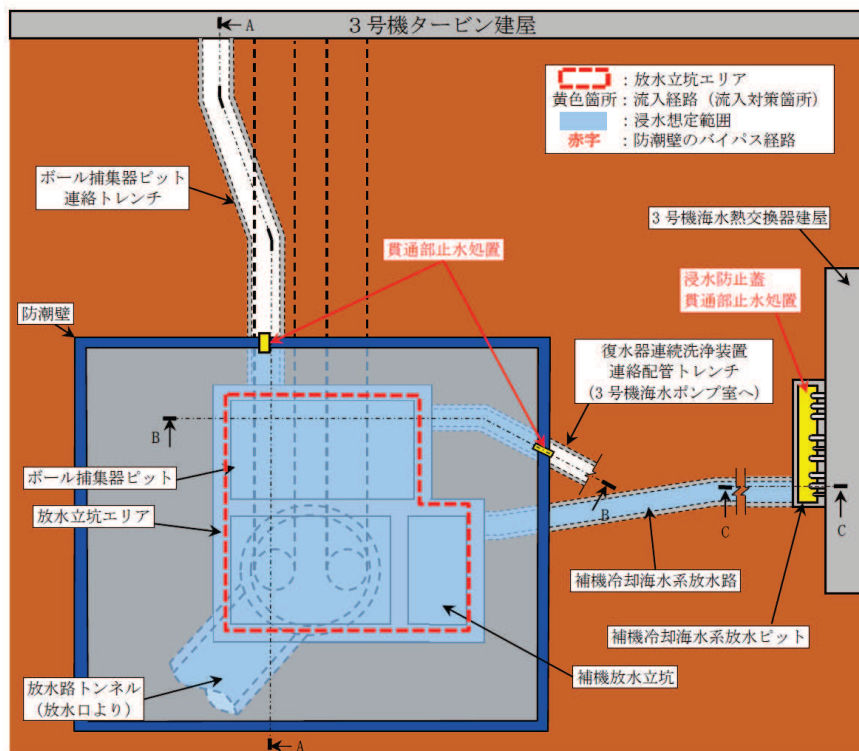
(15) 第 3 号機 放水立坑 流入対策配置図 (平面図)
